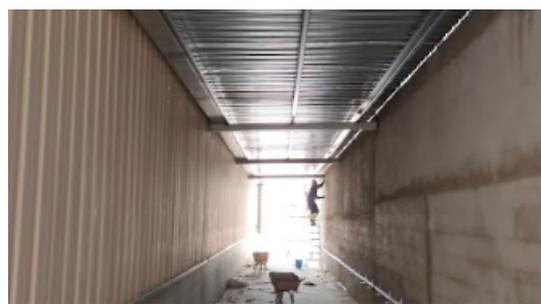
Picado mediante compresor eléctrico en sitios donde la máquina no puede acceder para la realización de zanjas para evacuación de aguas pluviales de la nave,
